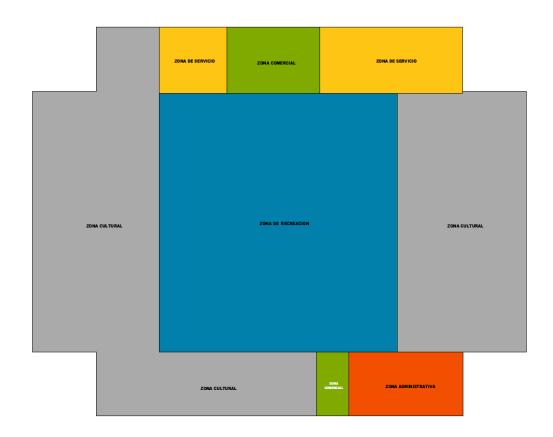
Zonificación planta baja (fuente: elaboración propia)
